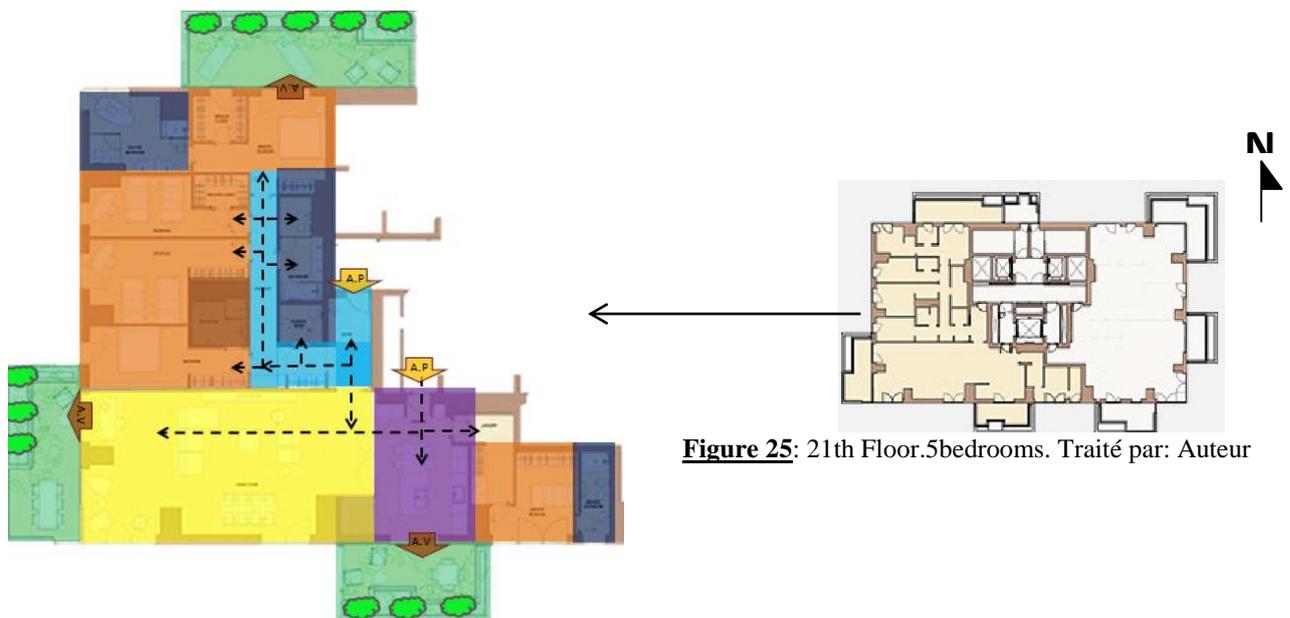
21th Floor. 5 bedrooms. Traité par: Auteur
